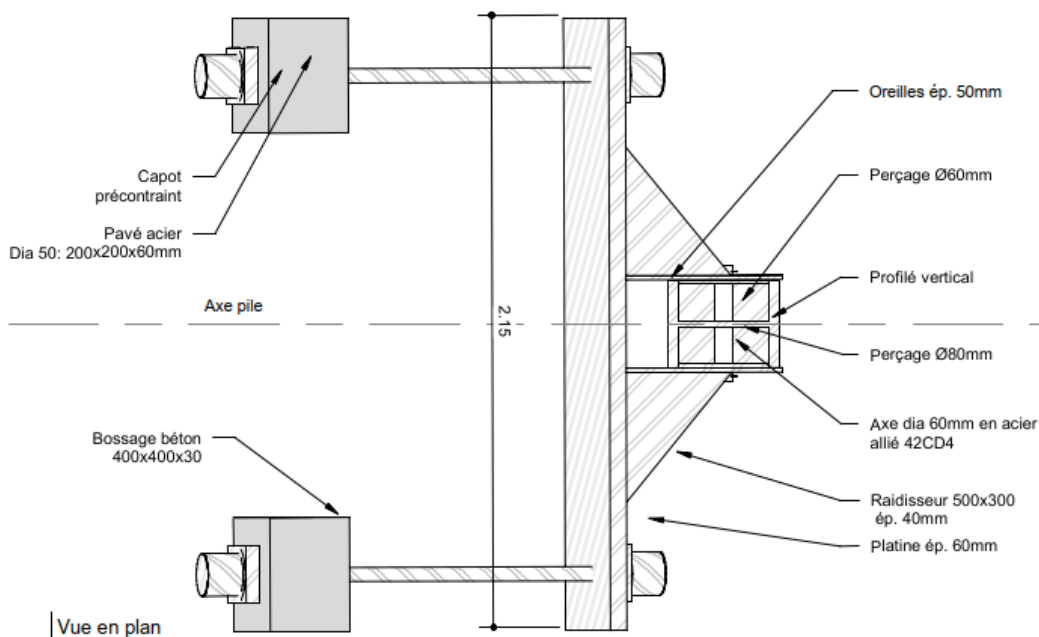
Vue en plan du détail de l'ancrage haut pour un voussoir sur pile (droite)
